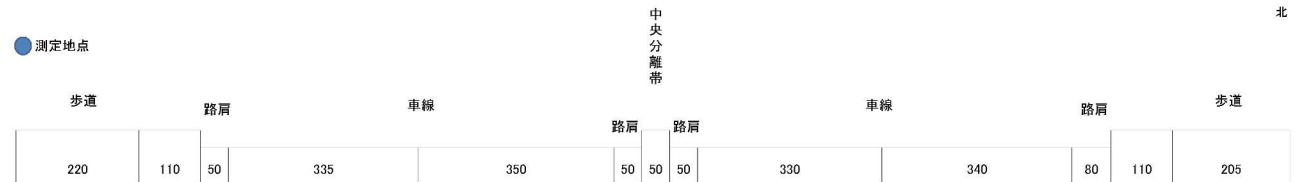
(4) 予測断面図 (地点 7 : 曙小学校前)
